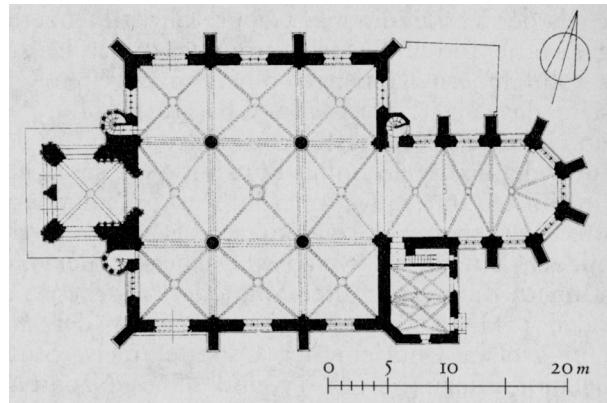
Grundriss, Nürnberg, Frauenkirche
